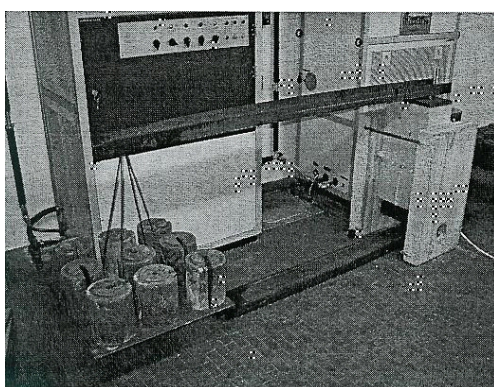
Ensaio de longa duração em ligações mistas madeira-betão (fotos retiradas de [60, 93, 146]).
